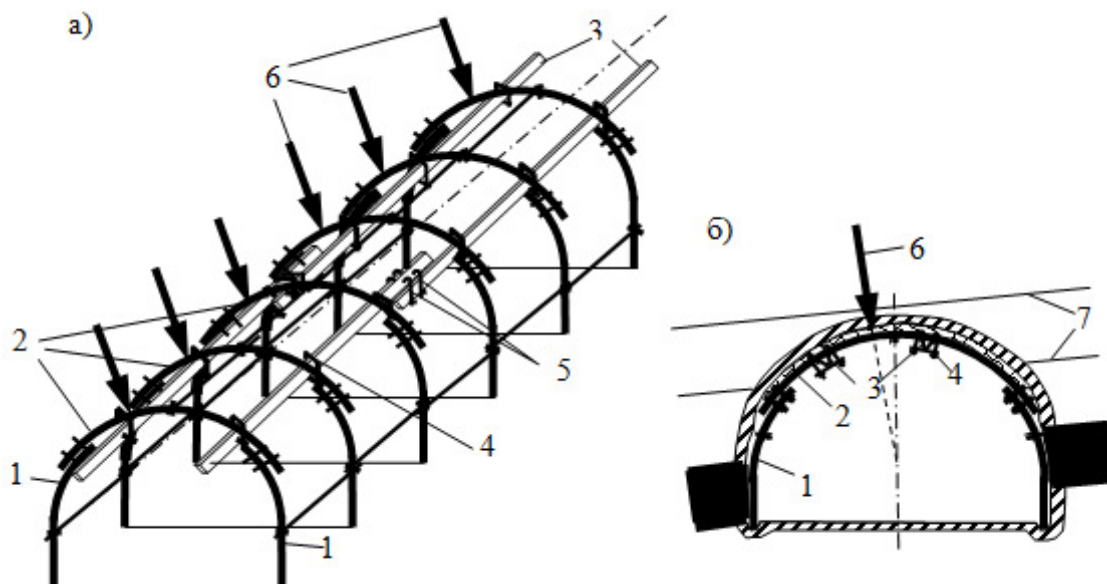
Схема расположения двойной продольно-балочной крепи усиления по длине подготовительной выработки (а) и в ее поперечном сечении (б): 1 – стойки рам основной крепи; 2 – верхняки крепи; 3 – продольные балки усиливающей крепи; 4 – соединительные хомуты для подвешивания балки к верхнякам крепи; 5 – соединительные крючья с планками для связи отрезков балки; 6 – направление вектора максимального горного давления на раму крепи; 7 – плоскости напластования пород кровли
